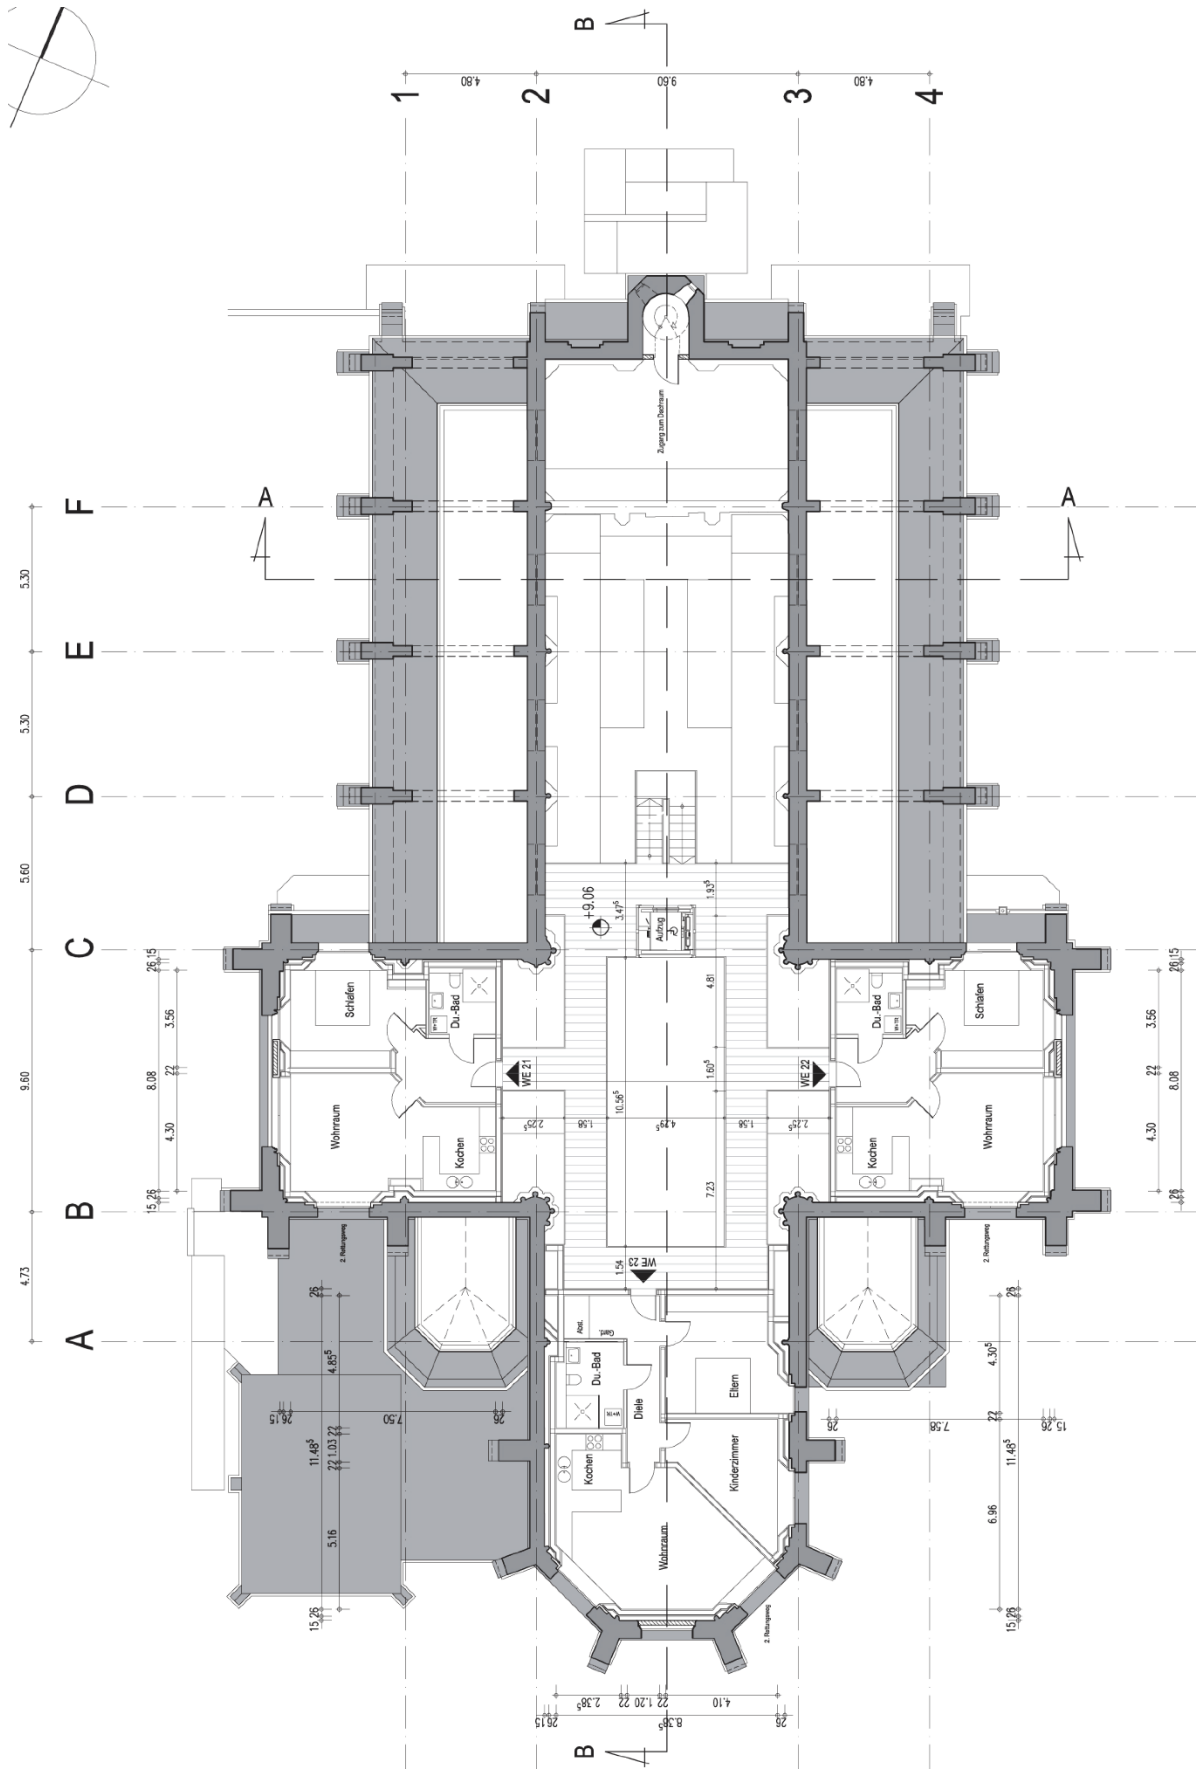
Grundriss 3.Obergeschoss
